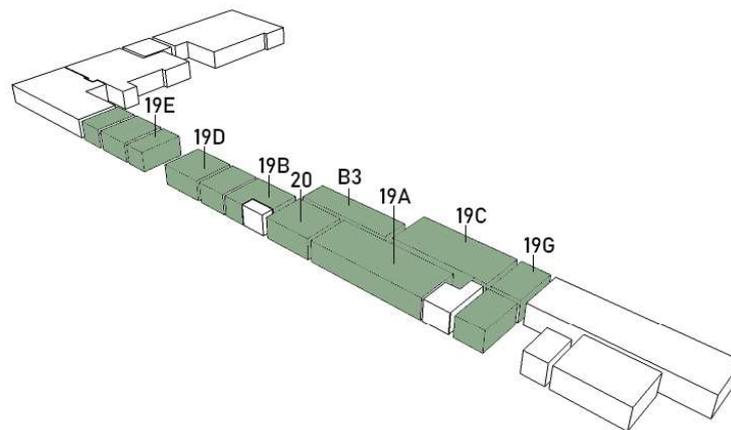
Schema tridimensionale con individuazione dei locali dedicati alla biblioteca, piano primo.
